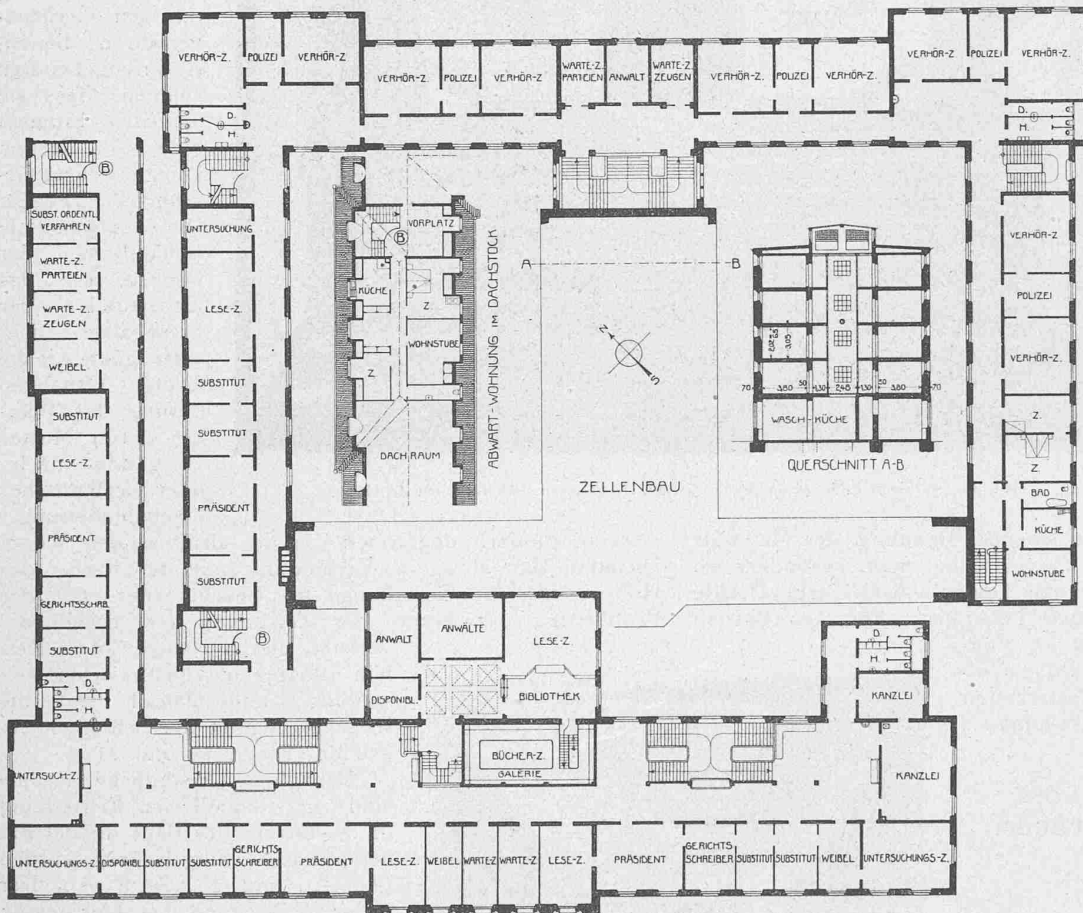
Grundriss vom II. Stock. — 1:600. (Die Grundrisse auf Abb. 11 und 12 sind ineinandergeschoben).
